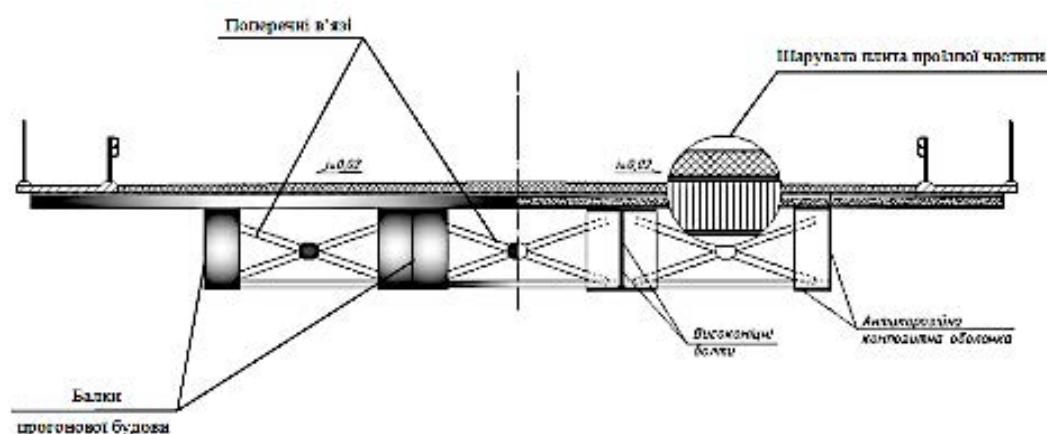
Приклад конструкції мостової прогонової будови з шаруватою плитою (поперечний переріз)
